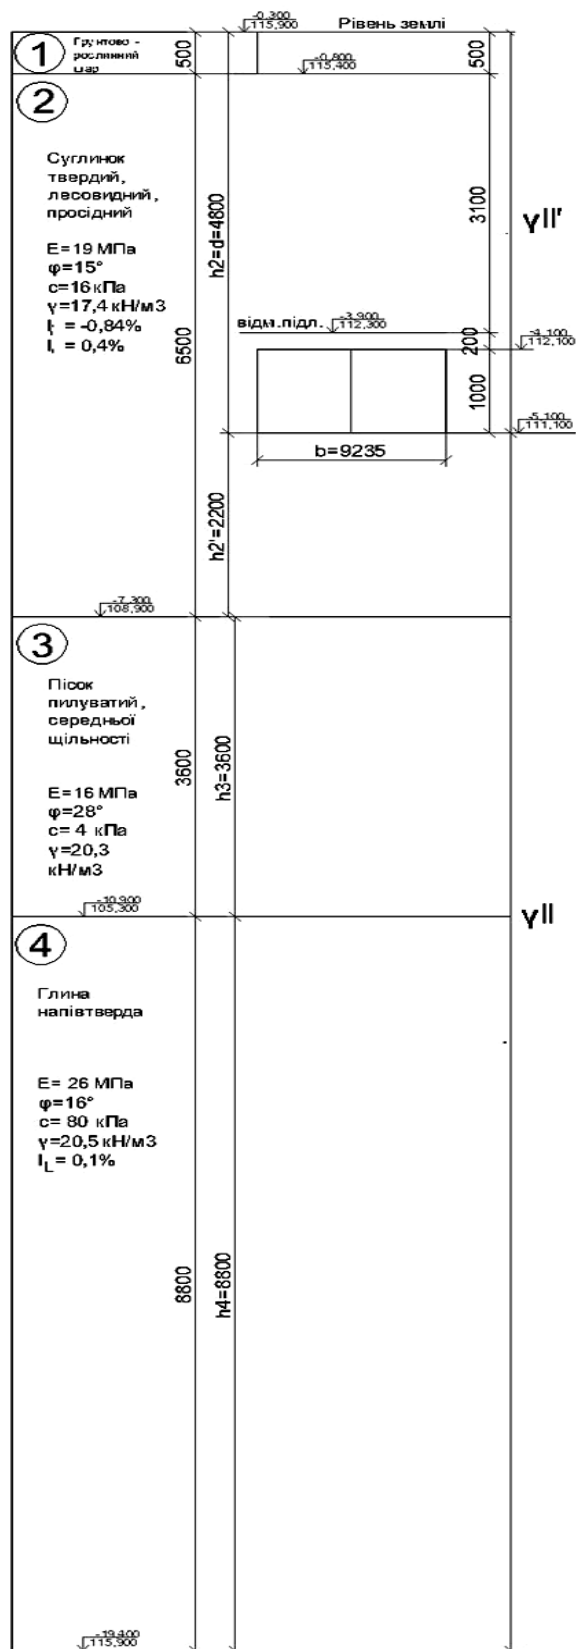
Схема до розрахунку питомих ваг ґрунту вище та нижче підшови фундаментної плити
